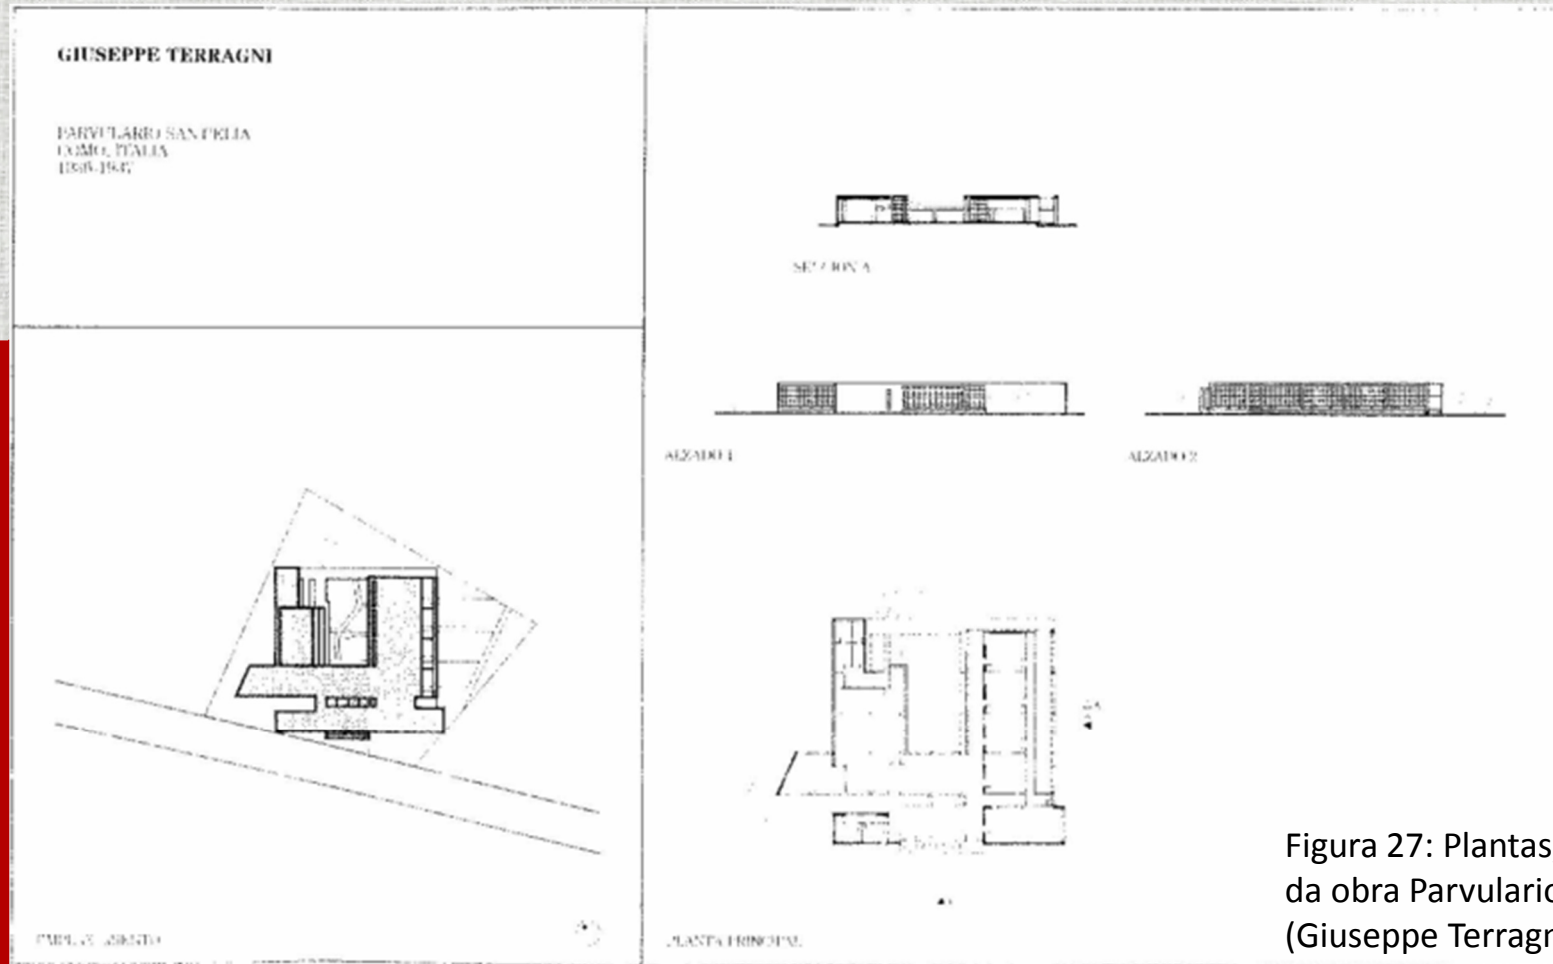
Plantas, Cortes e Fachadas da obra Parvulario Santella, Itália (Giuseppe Terragni, 1936 – 1937)
